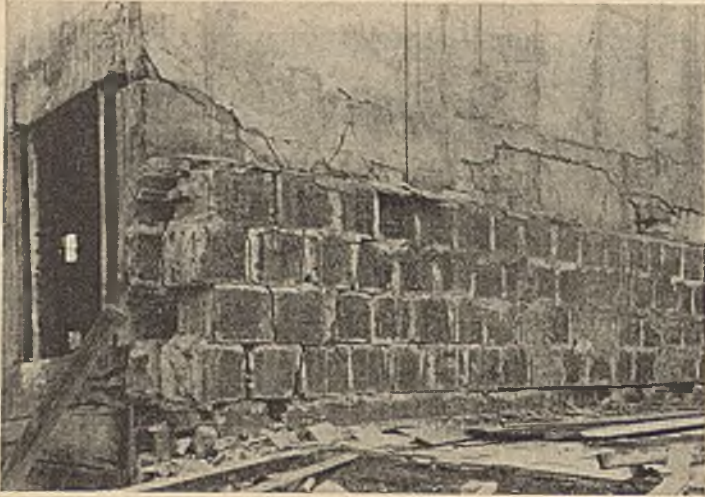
Gebäude der Buick-Agentur: Rückwand des Gebäudes mit Eingang zum Personenaufzug (noch im Rohbauzustand). — Der beschädigte Eckpfeiler (an Trägerunterkante) ist deutlich zu erkennen; Notstützen sind eingezogen. — Auch Putzabsprengungen sind wahrzunehmen. — Die Sandsteinquader der Mauer im Vordergrund gehören zum Nachbargrundstück.
